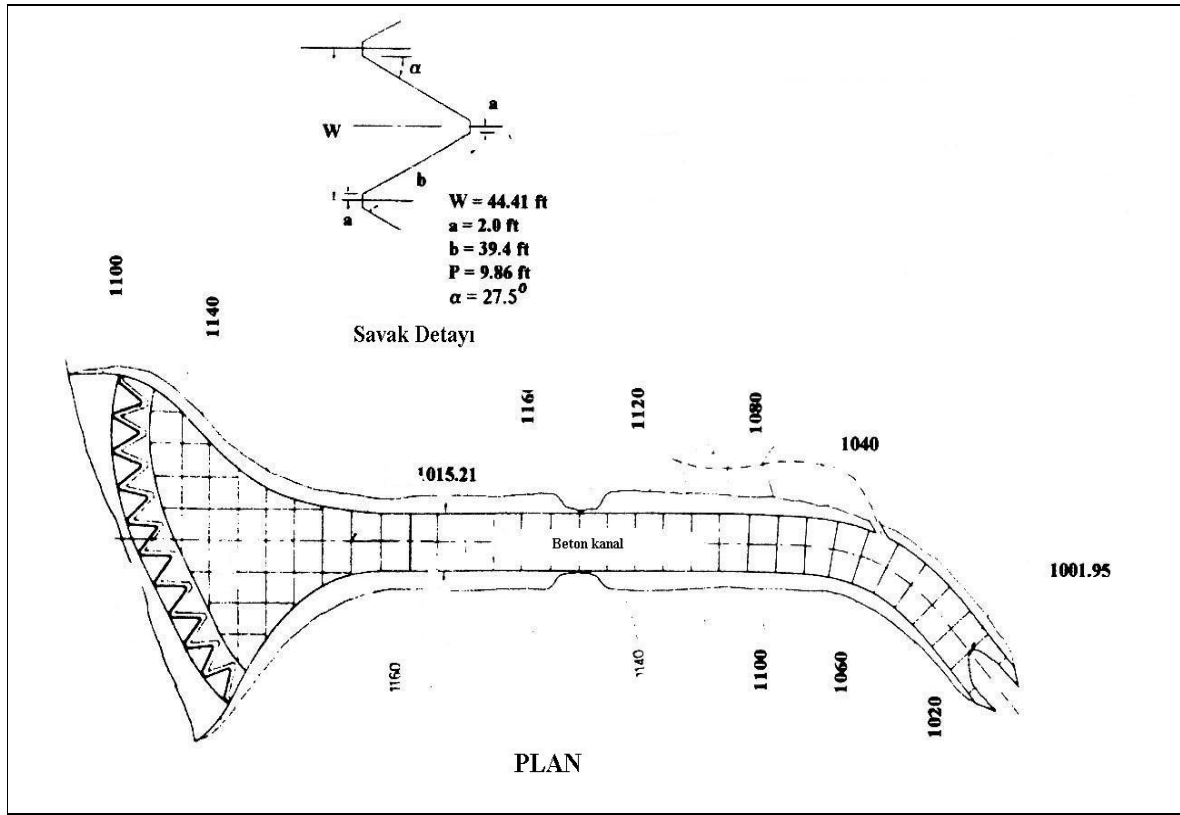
Kızılcapınar Barajı Labirent Dolusavak Yerleşim Planı, Kesit ve Detayı [52]
